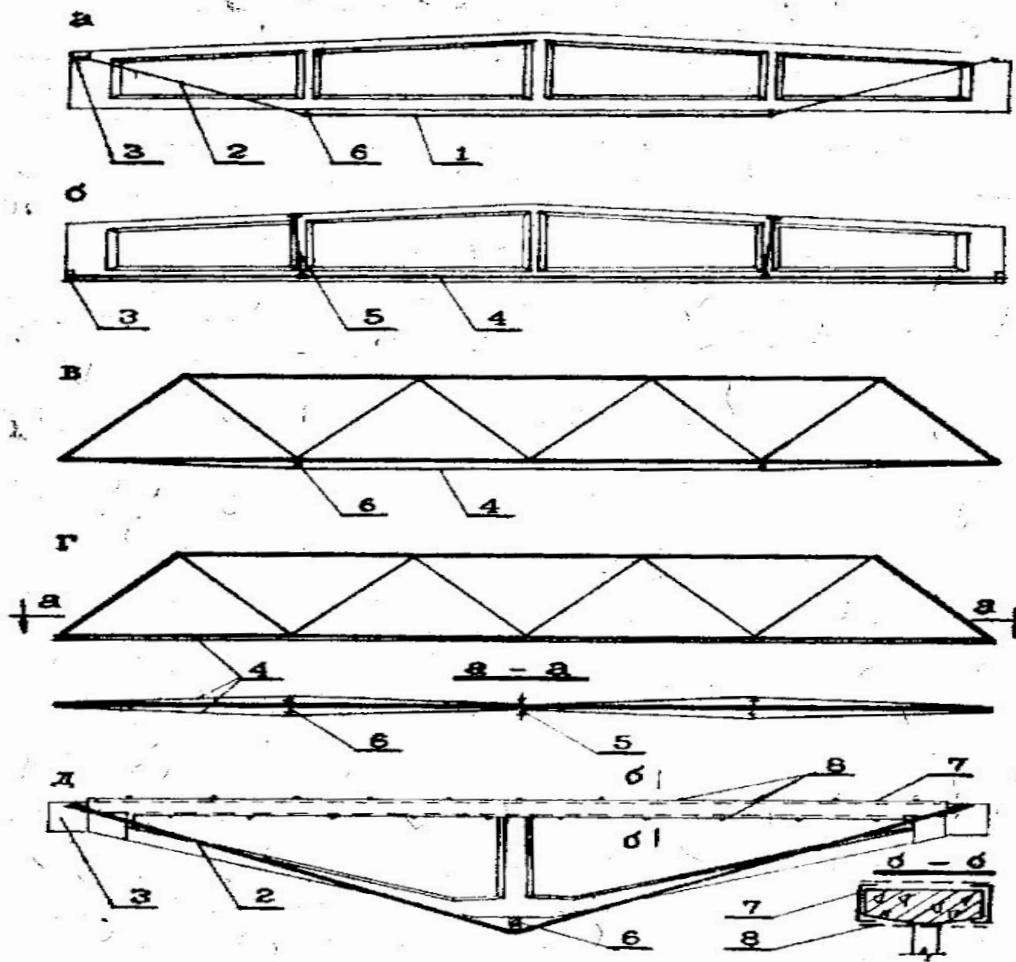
Усиление железобетонных несущих конструкций покрытия:
